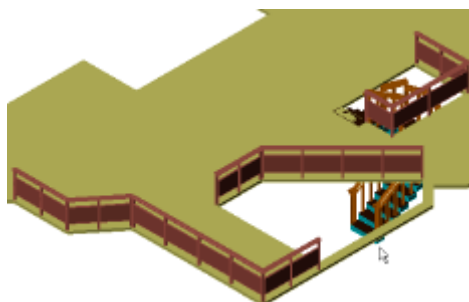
Layout da sacada, mezanino e escada do segundo pavimento após desenho do gradil.
